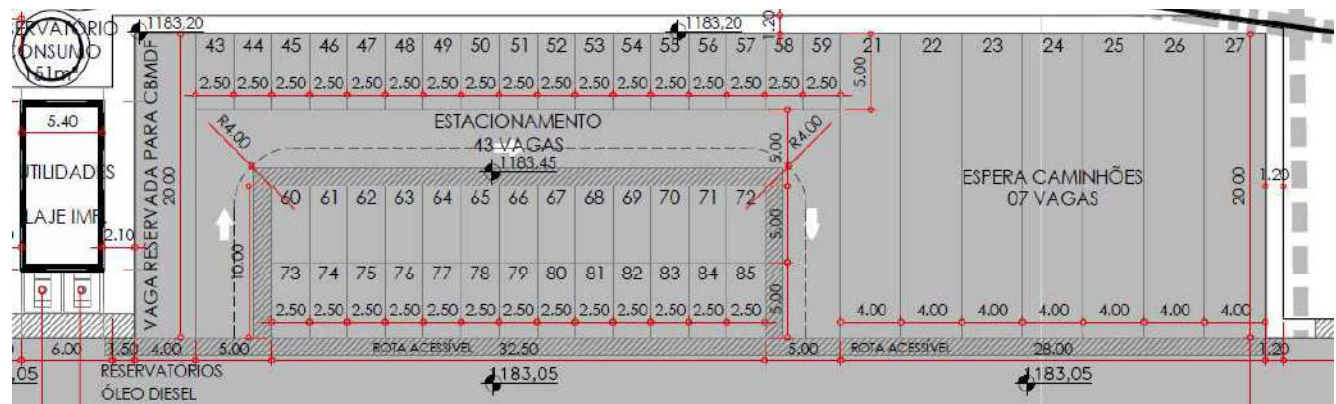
Identificação das rotas acessíveis a pedestres no estacionamento interno de caminhões e carros. Fonte: Recorte do Projeto de Arquitetura – R09, em anexo.
